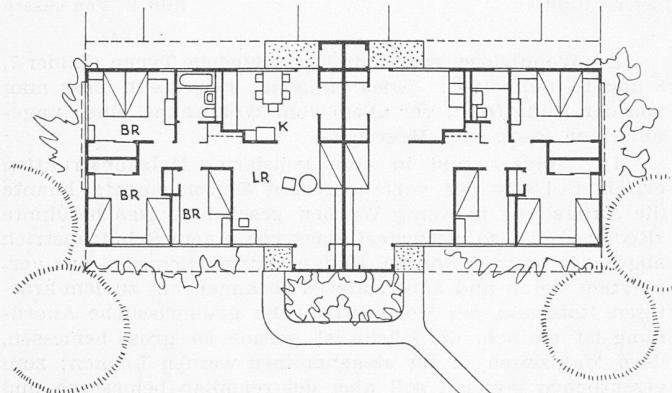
Einstöckiges Vierzimmer-Doppelhaus
